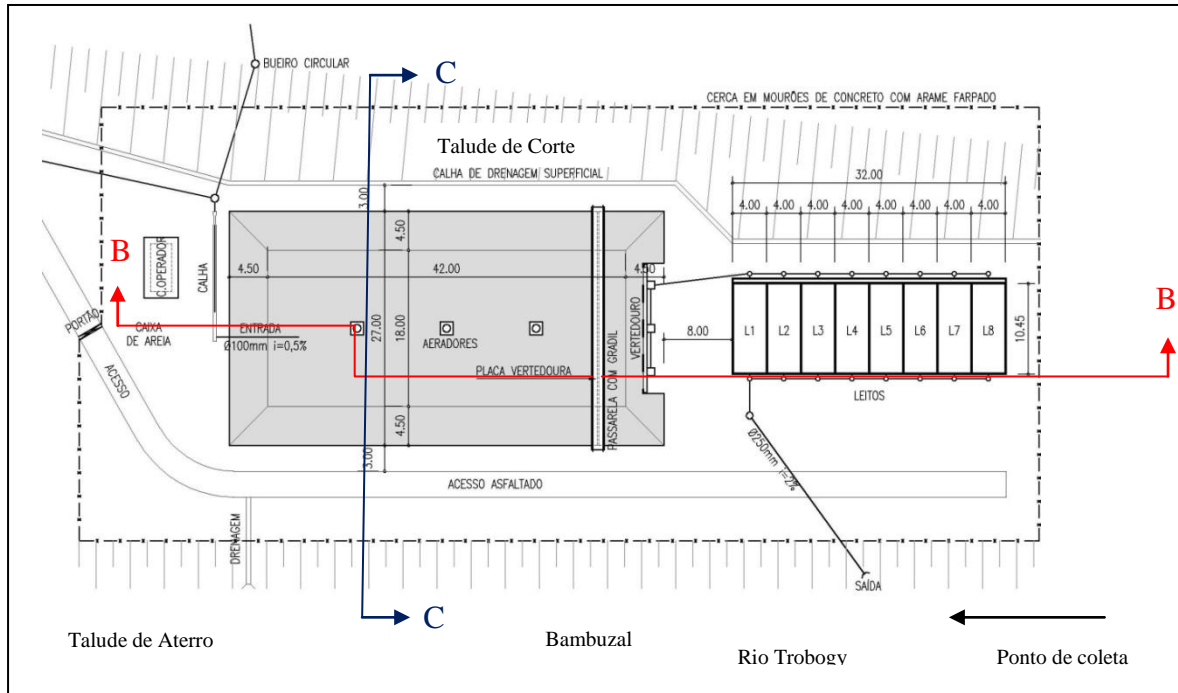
(a) – Planta baixa da lagoa e dos leitos de secagem
